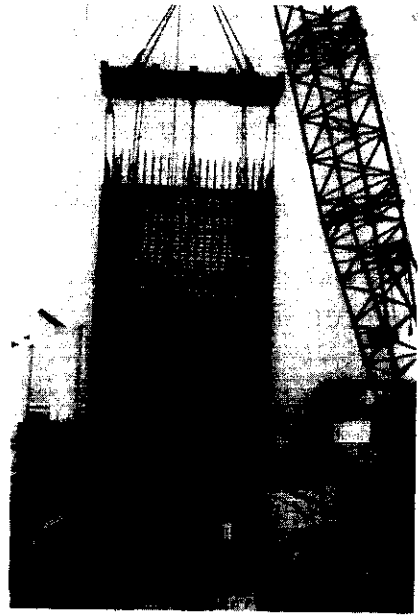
鉄筋籠（後行パネル）の吊上げ状況
